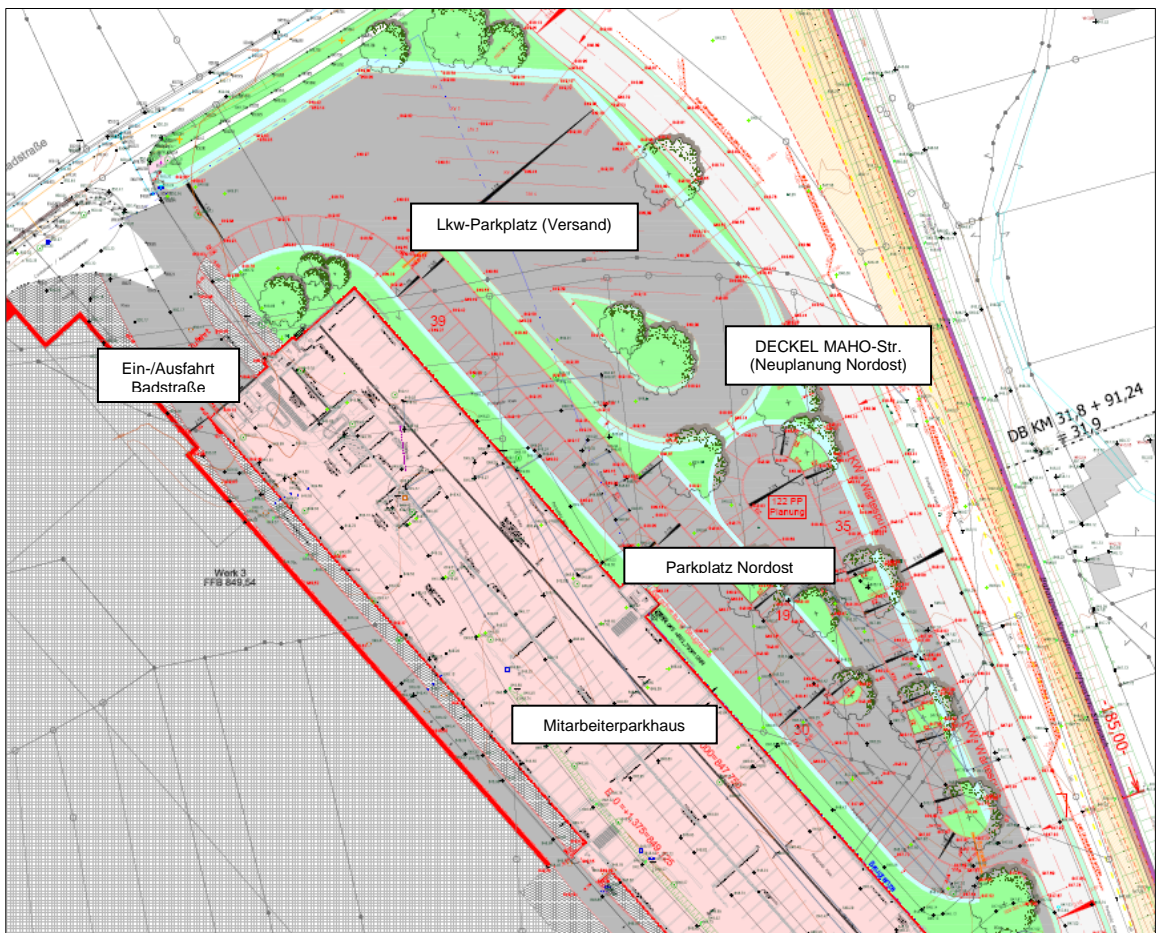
Lageplan mit Darstellung genehmigter Umbau-/Erweiterungsmaßnahmen gemäß [b]
